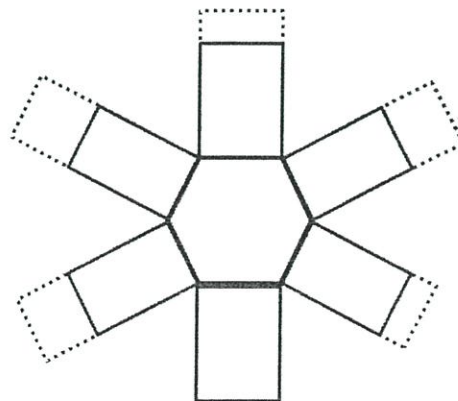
แสดงการขยายตัวแบบ Open Plan
